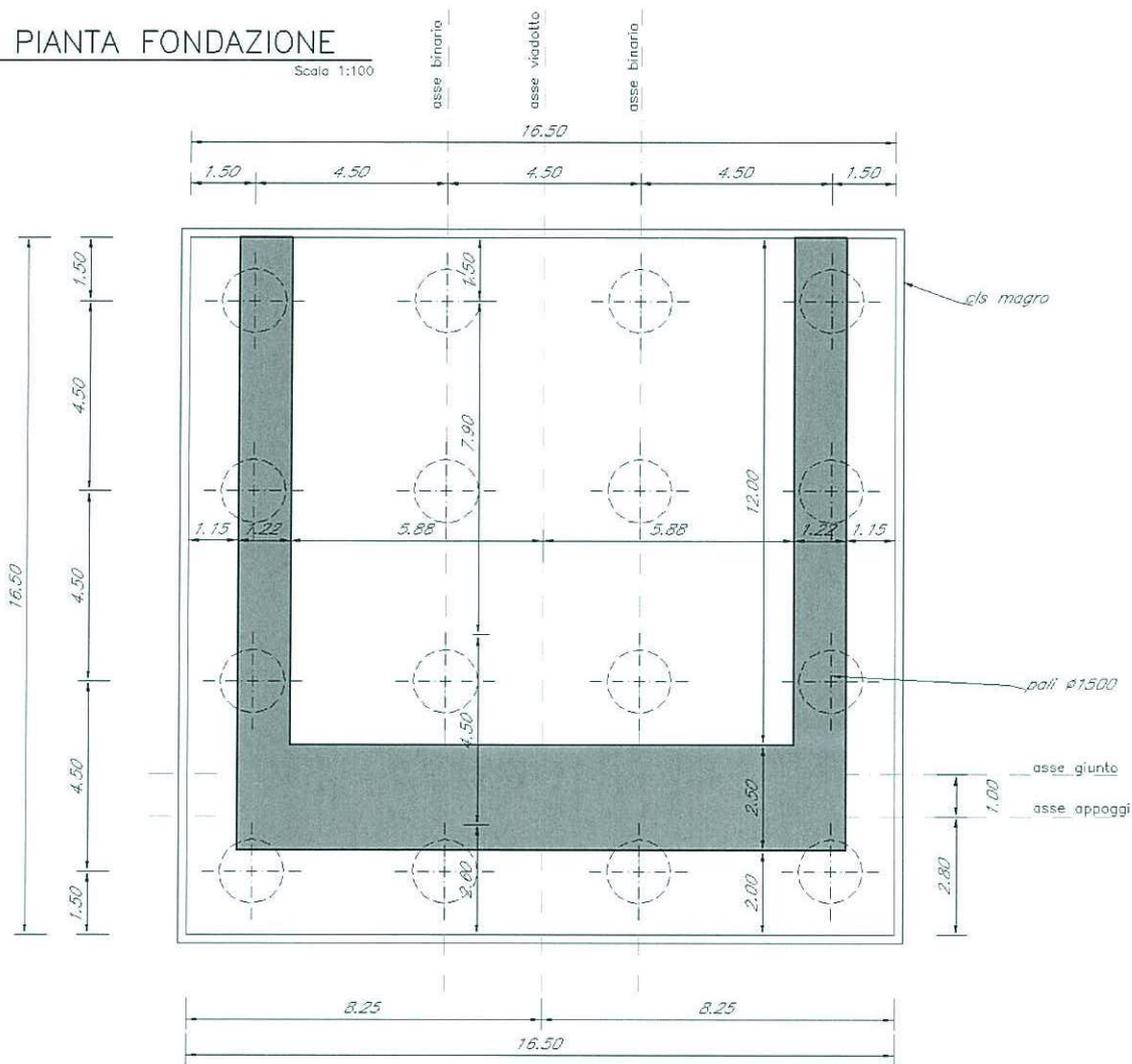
Pianta fondazioni della spalla tipo.
